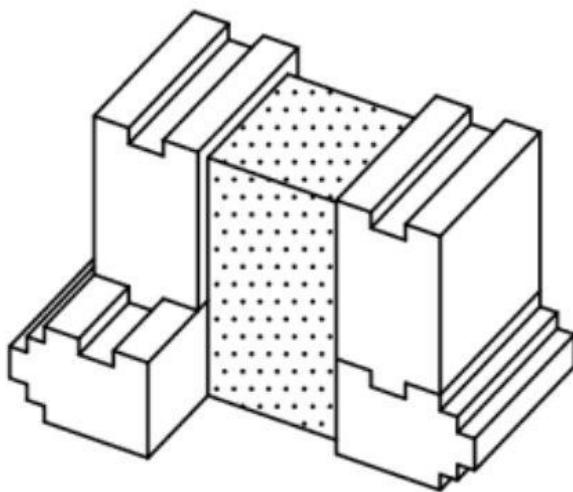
Pondasi batu tuf ditutup batu andesit
